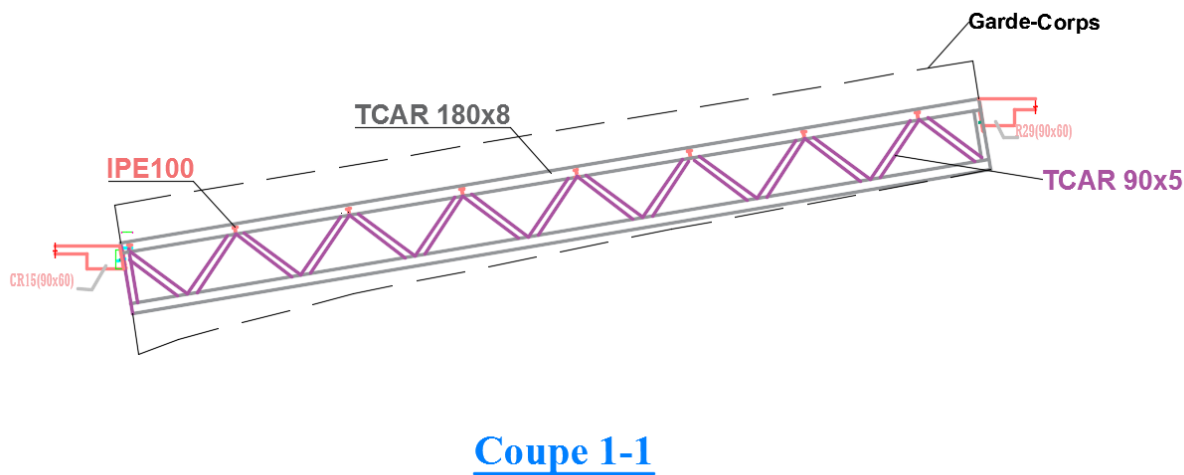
Coupe 1-1 de la poutre à treillis Warren sans montant en élévation
